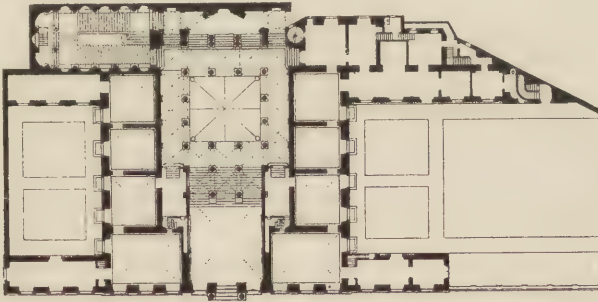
Palazzo Balbi-Durazzo zu Genua. (Jetziger Grundriss.)
